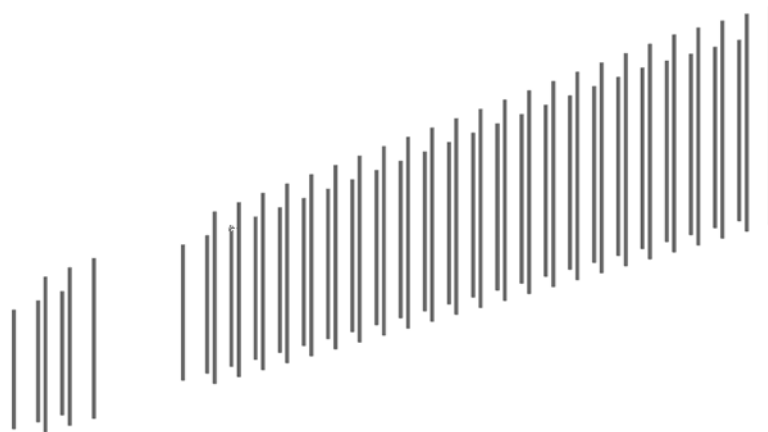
Vista tridimensionale dei pilastrini creati.
